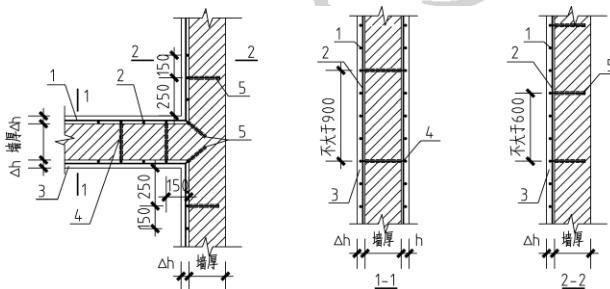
1 钢筋网水泥砂浆面加固大样
